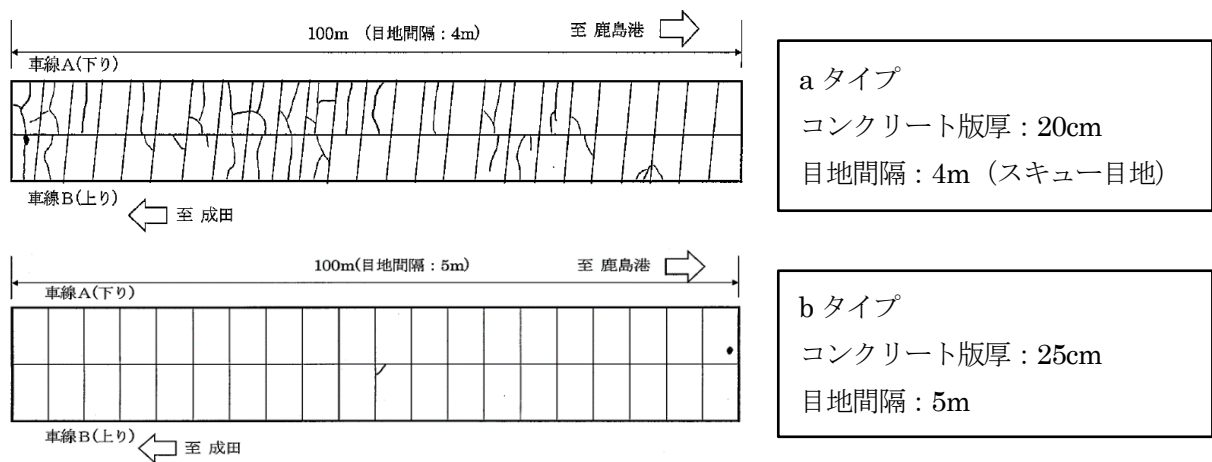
ひび割れ発生状況 (全体平面図)
